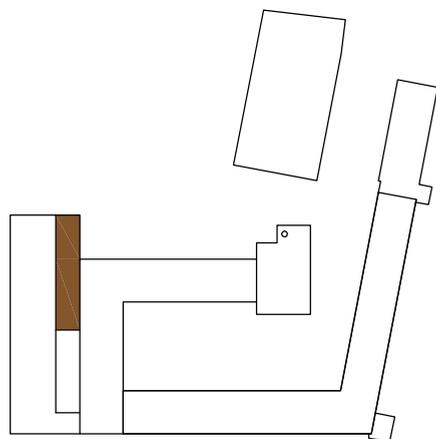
Plan zu Umbaumaßnahmen im Erdgeschoß des Friedhofstraktes, 1929
